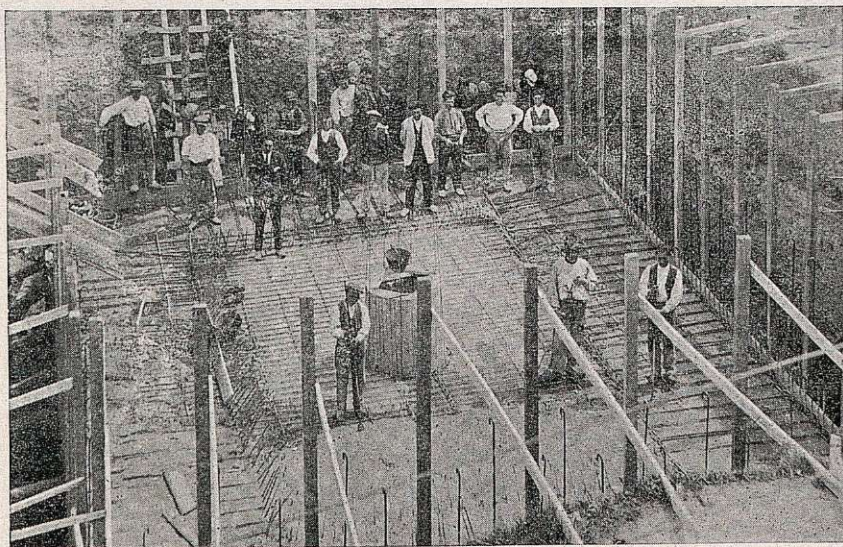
Cajón de un estribo del puente de Montesa menor.
